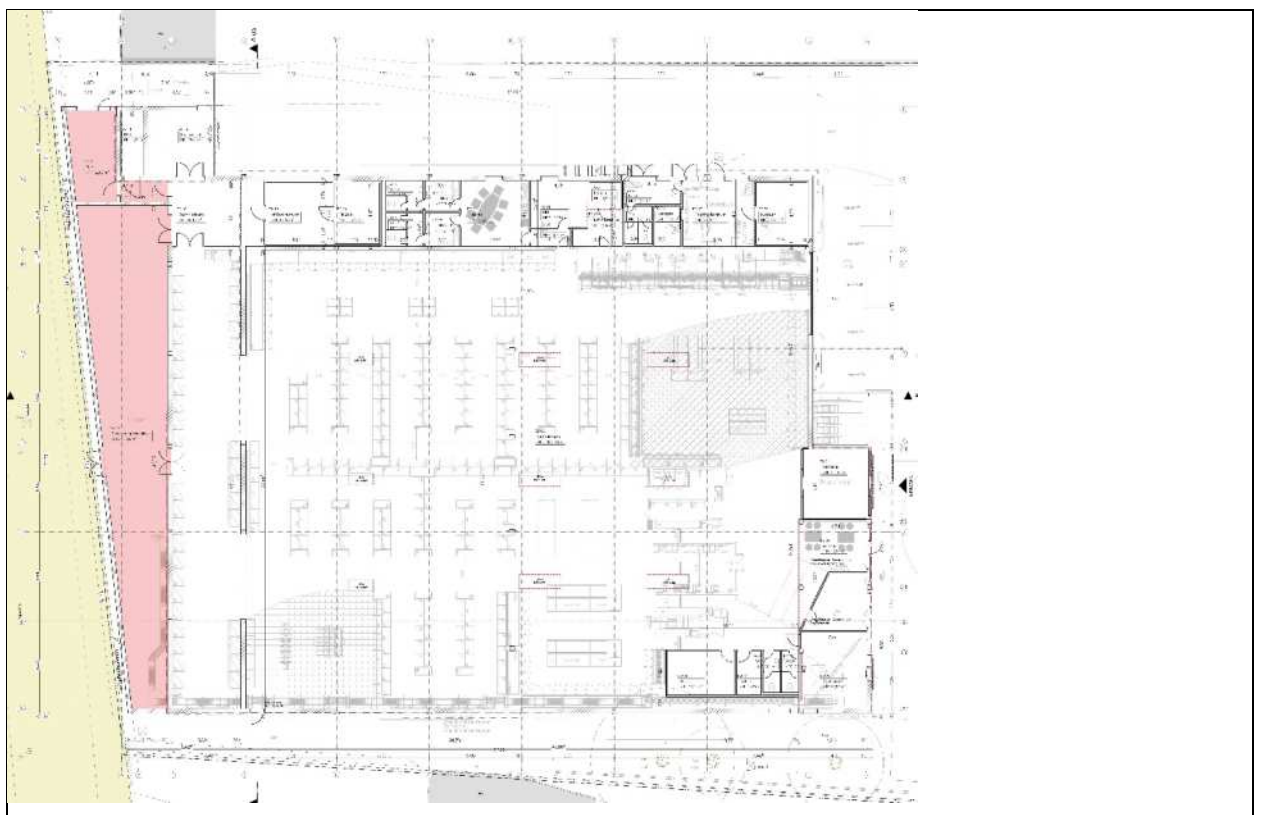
Grundriss Erdgeschoss mit Veränderungen gegenüber der aktuellen Situation
